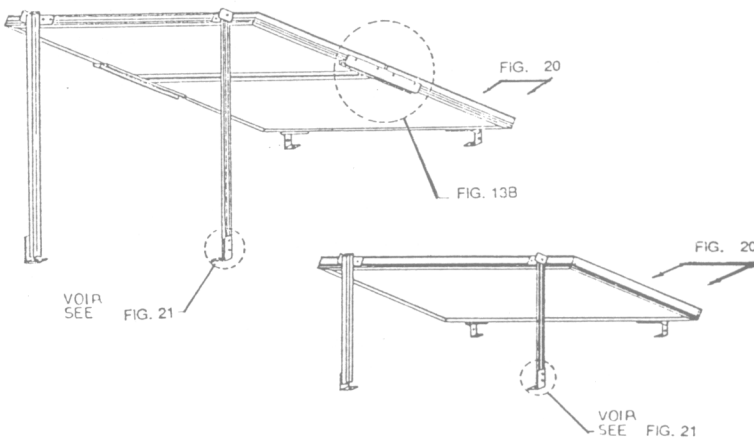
Détails de montage du bâti pour toit plat ou légèrement incliné (montage incliné).
